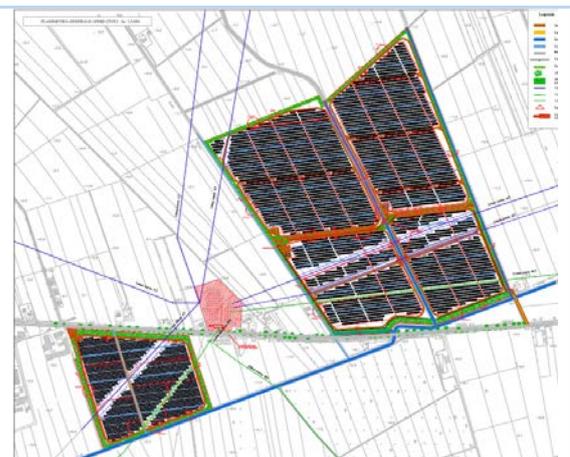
Impianto fotovoltaico con pannelli fissi, progettato nel 2010, ubicato nel Comune di Villadose. Planimetria
